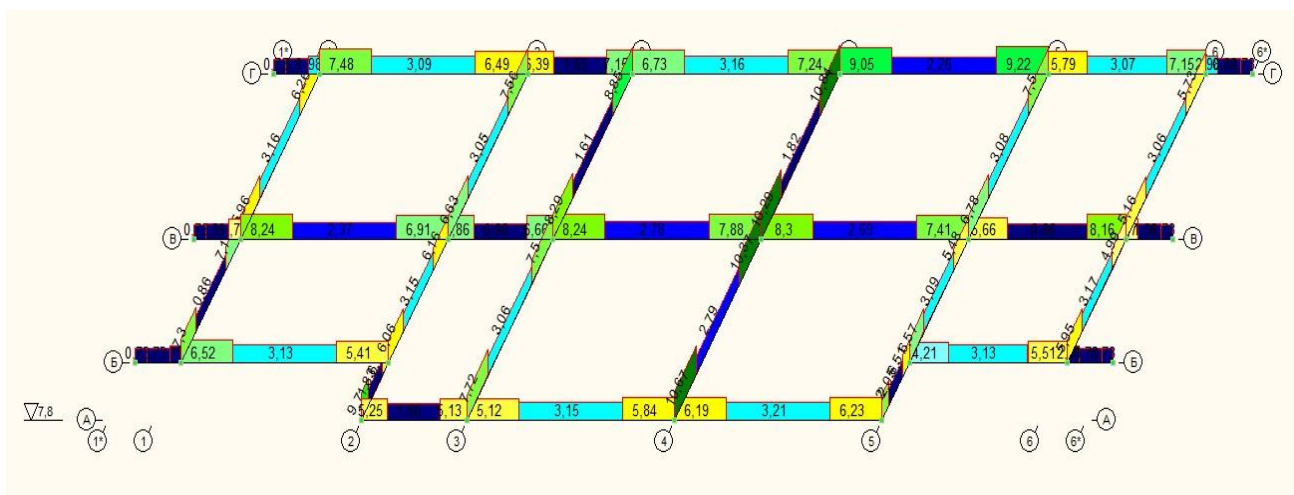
Сумарна площа поздовжньої арматури, см
